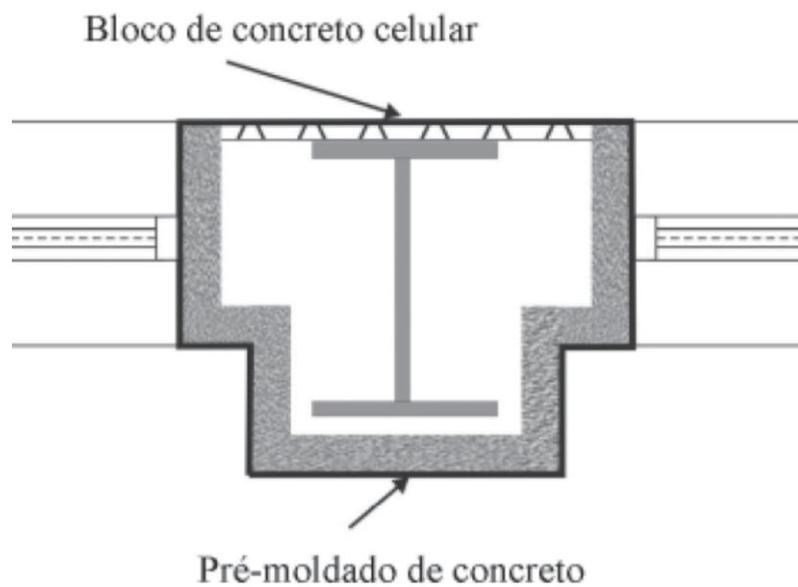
Pilar de fachada com elemento pré-moldado.
